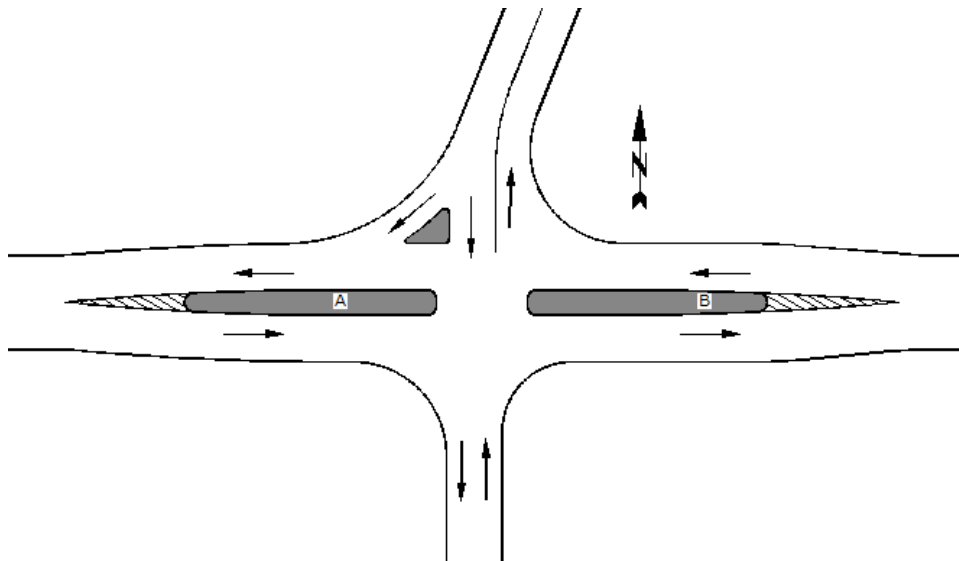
Isletas separadoras conservando ancho de calzada.
